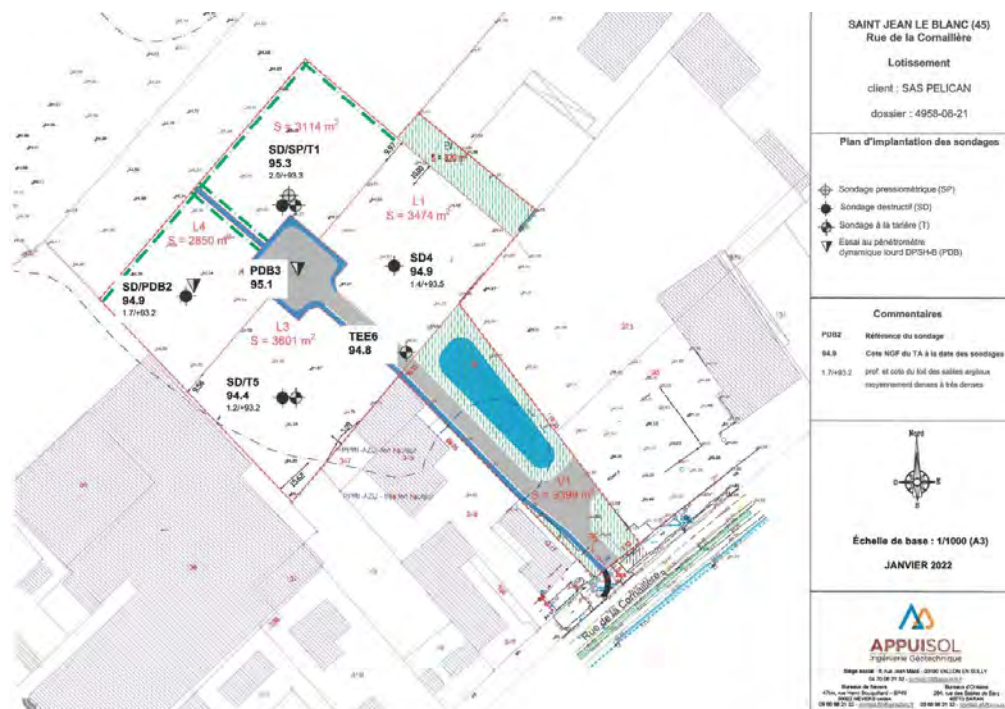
Plan d'implantation des sondages – Source : Appuisol
